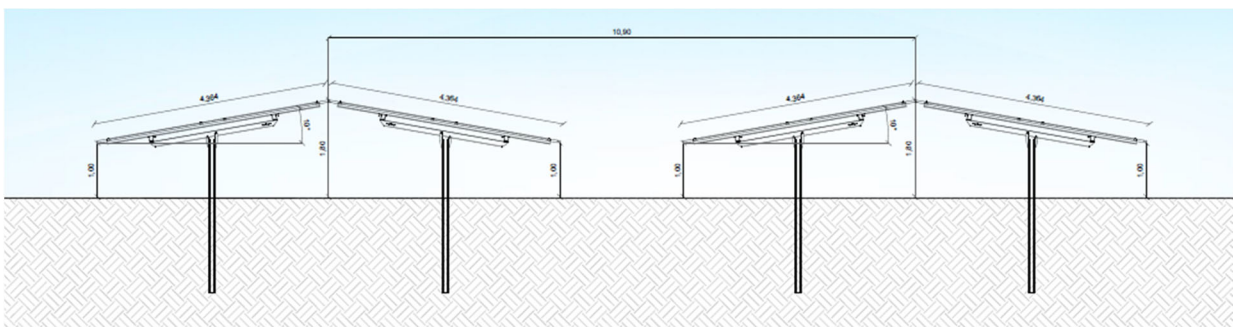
Sezione Tipo Strutture 2V (e-w)
